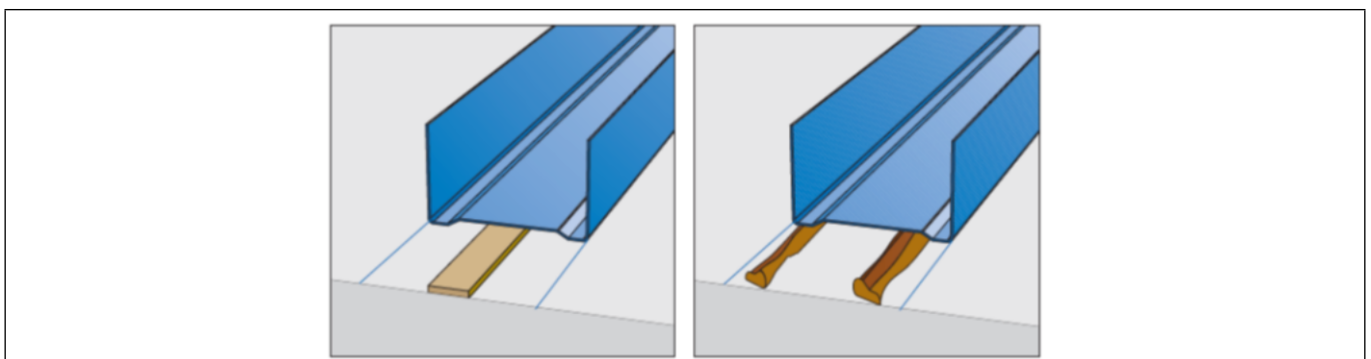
Local EB+ collectif ou EC - Protection en pied de cloison - Cas de finition par carrelage.
